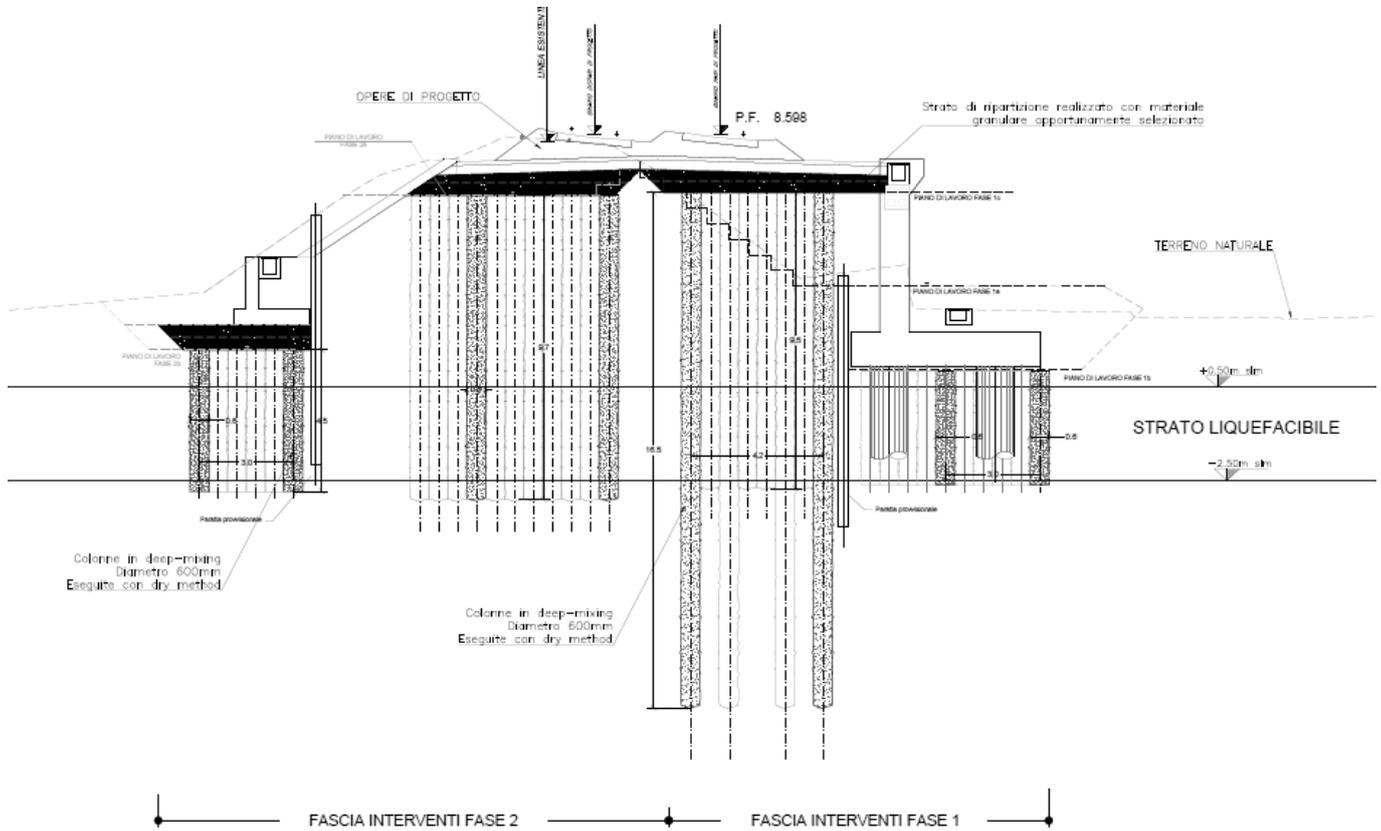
Sezione tipo con consolidamento con deep-mixing
